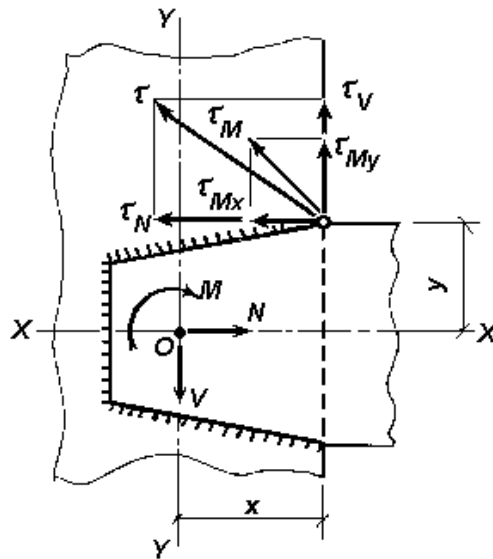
Розрахункова схема зварного з'єднання з кутовими швами
